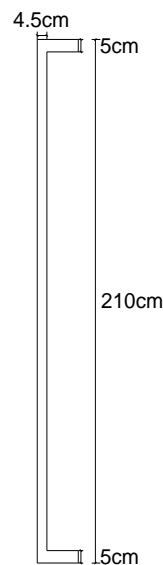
Sección transversal para el firme más las nervaduras laterales
